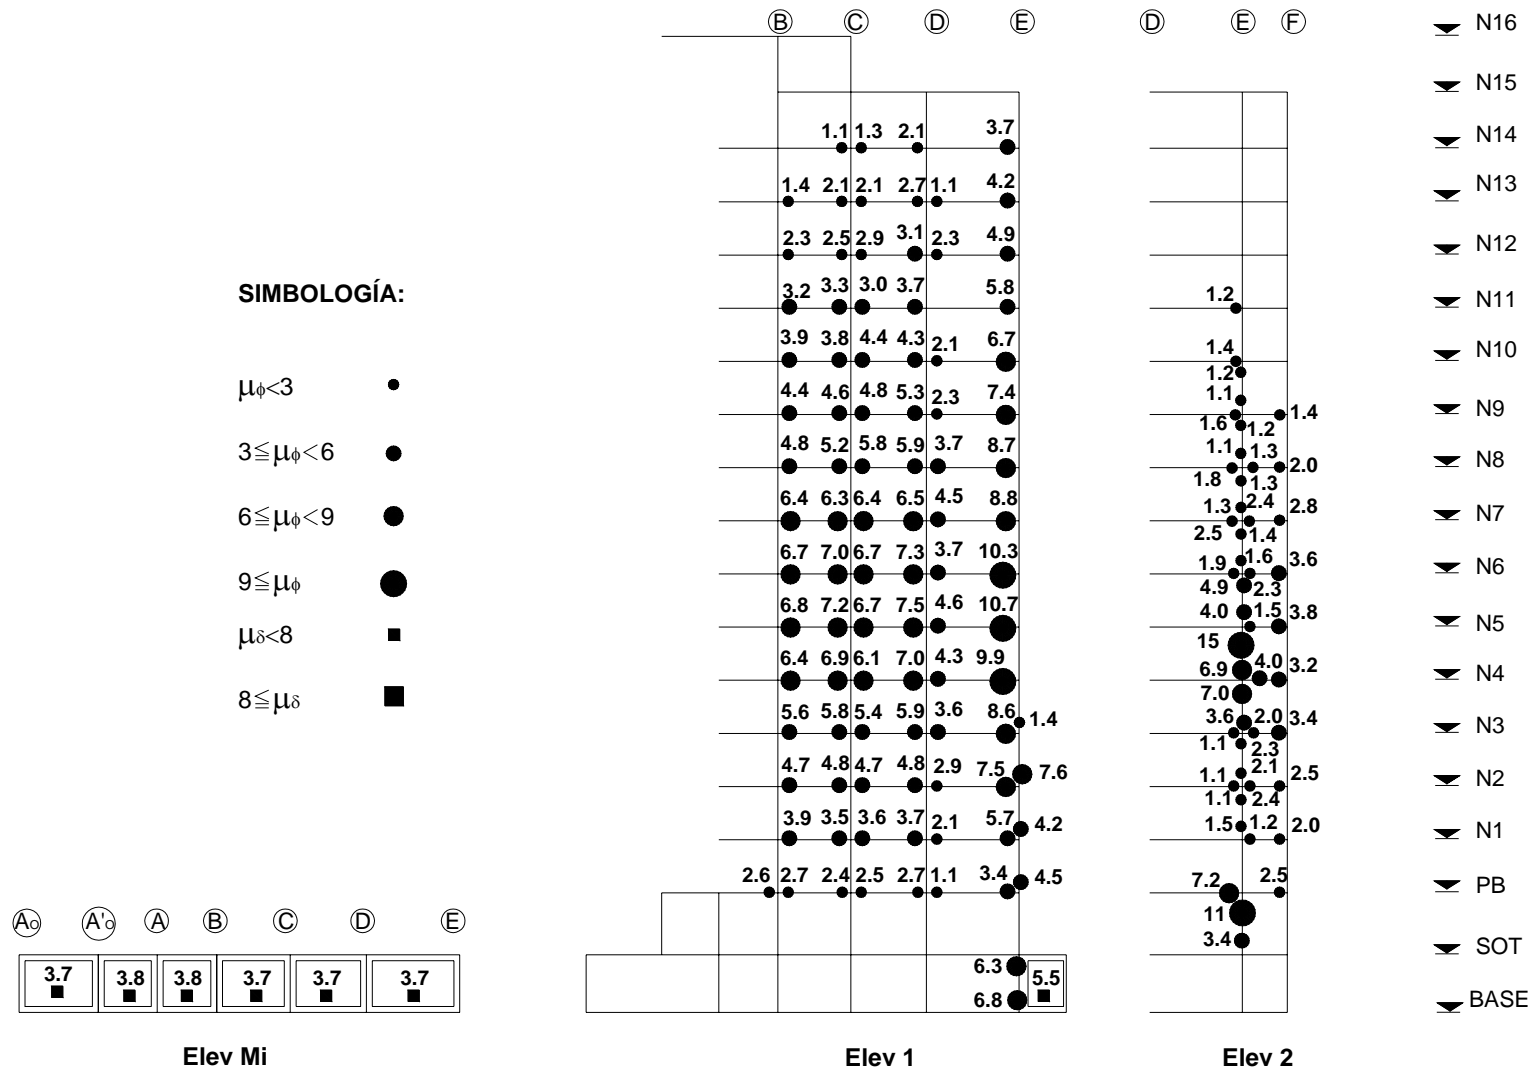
Ductilidades locales máximas de vigas, columnas y muros de concreto reforzado, en las elevaciones Mi, 1 y 2, para la SIM64
